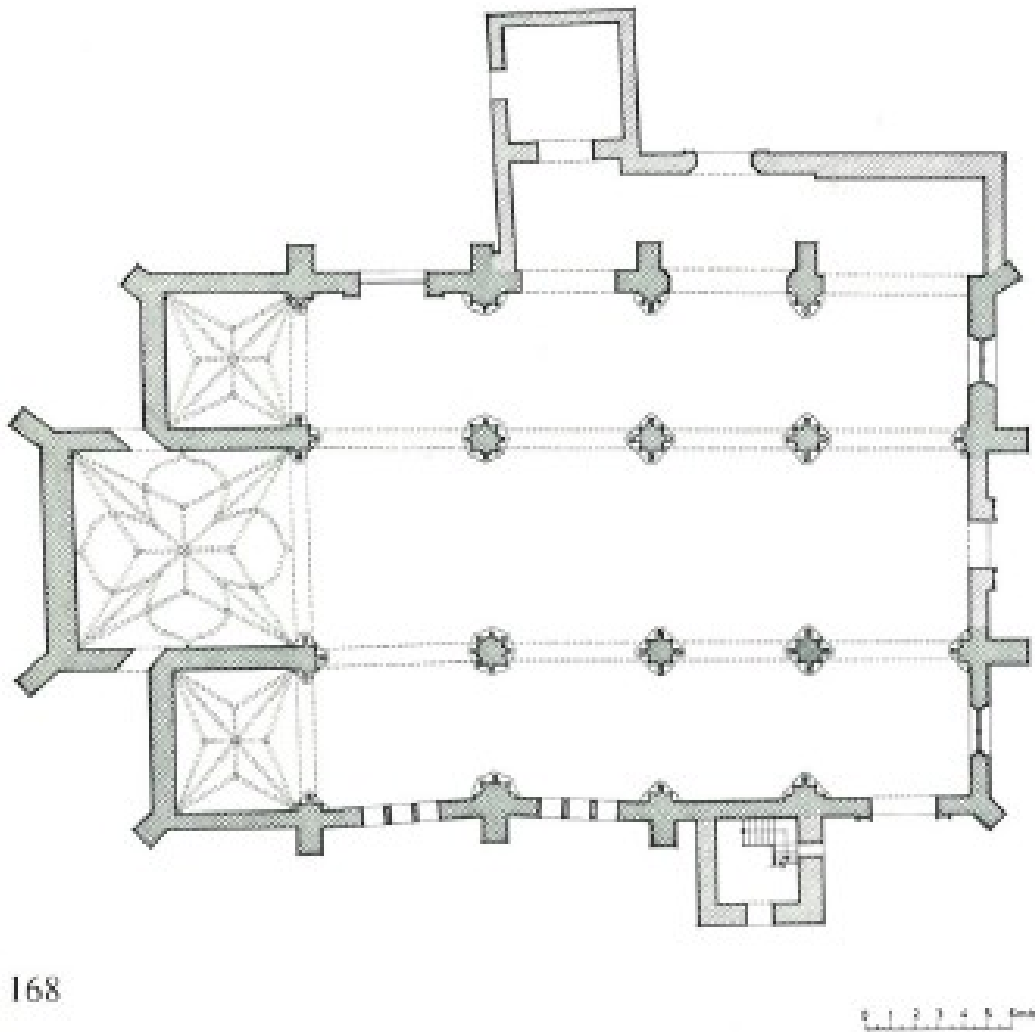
Planta de la restauracion de SMLM Arqto. J. A. Gómez Luengo
